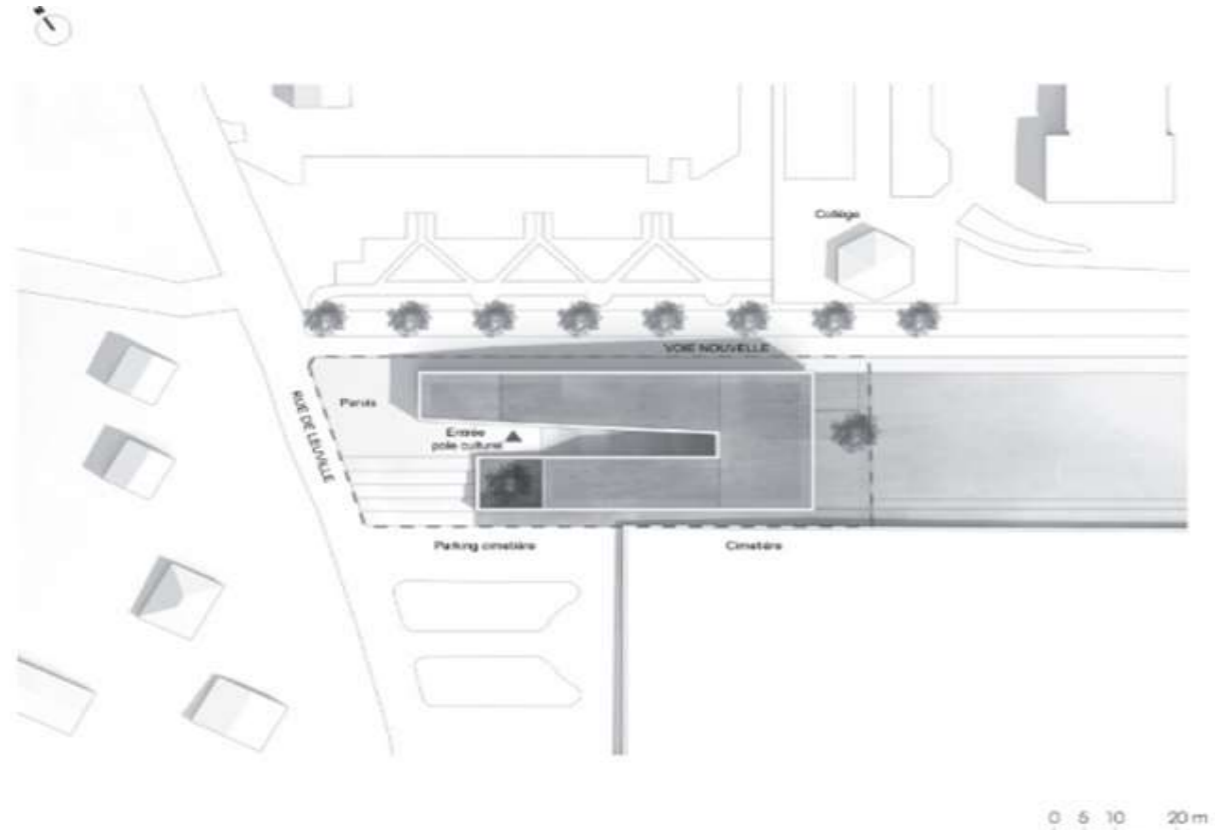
le plan de masse du terrain (source: www.darchitecture.com)
